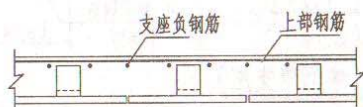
叠合层中板支座负钢筋及分布钢筋配置示意图
